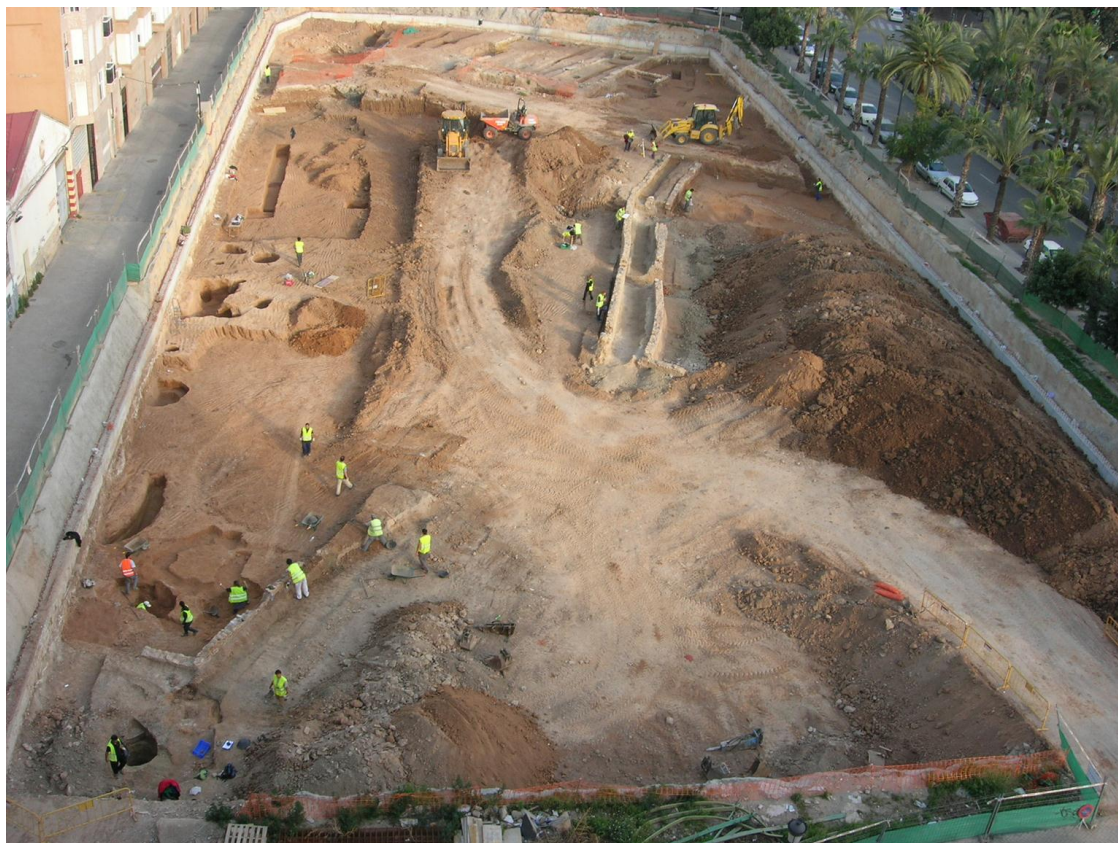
Planta de la excavación de Constitución, 58 en la que podemos observar en el centro el pozo presentado ibérico (Imagen: Salavert y Ruiz 2007)
